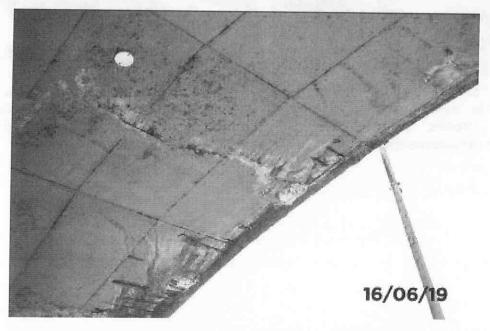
Detalhe na laje de trincas, eflorescência e armadura exposta.
